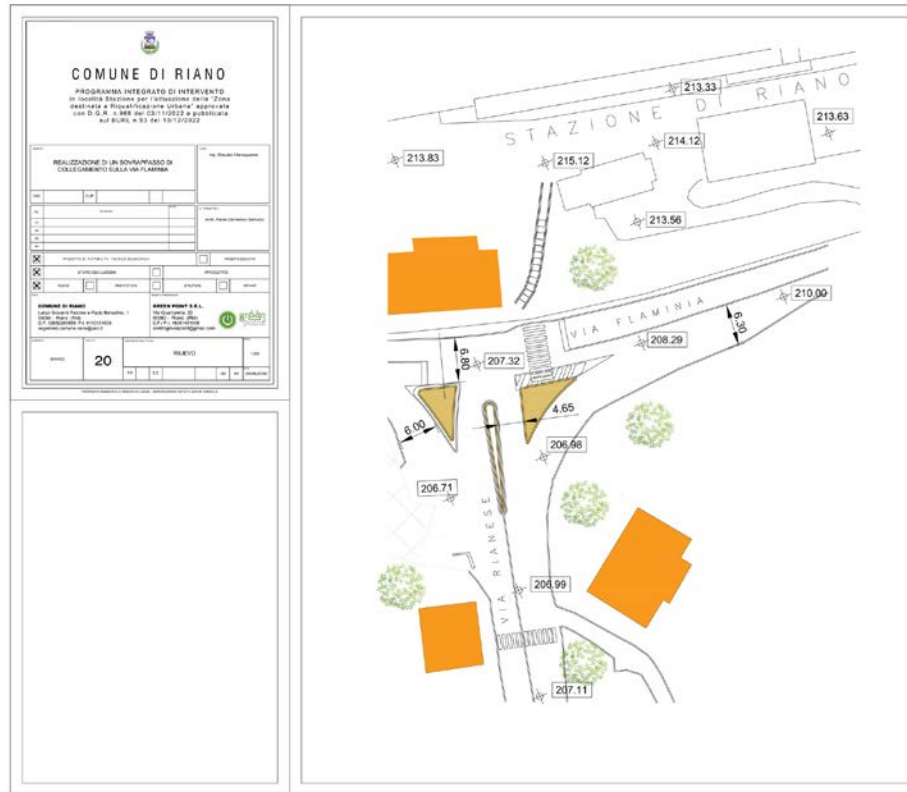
A20: rilievo plano-altimetrico dell'area di intervento.
